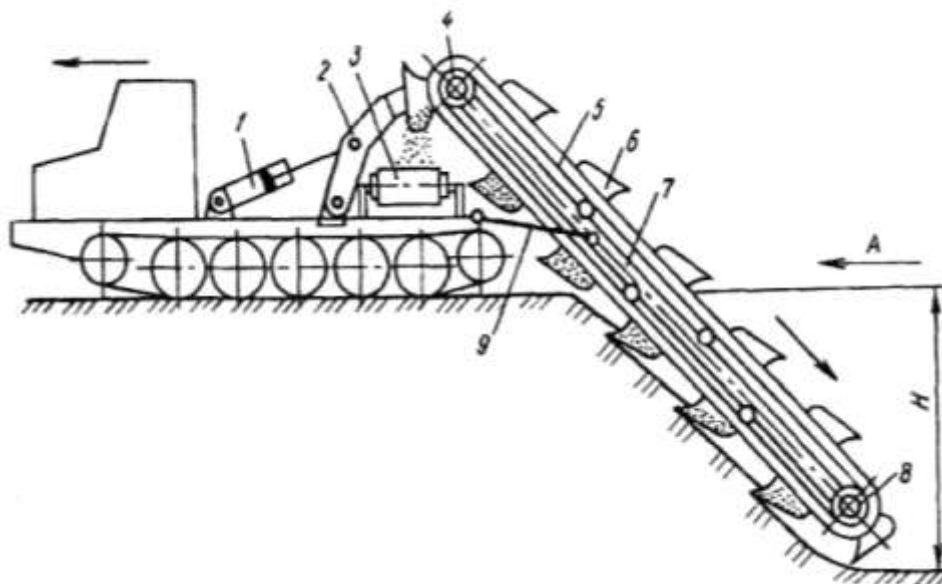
Конструктивна схема ланцюгового багатоковшового траншейного екскаватора:
